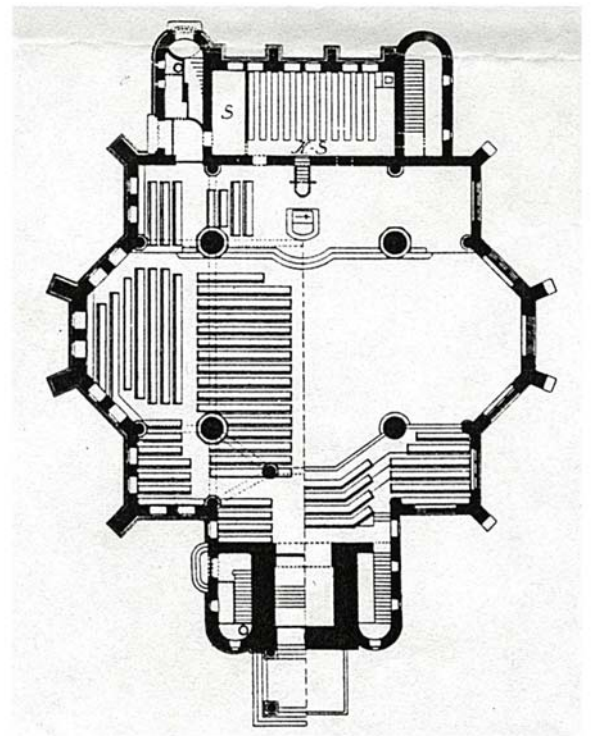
Grundriss Erd-/Emporengeschoss
